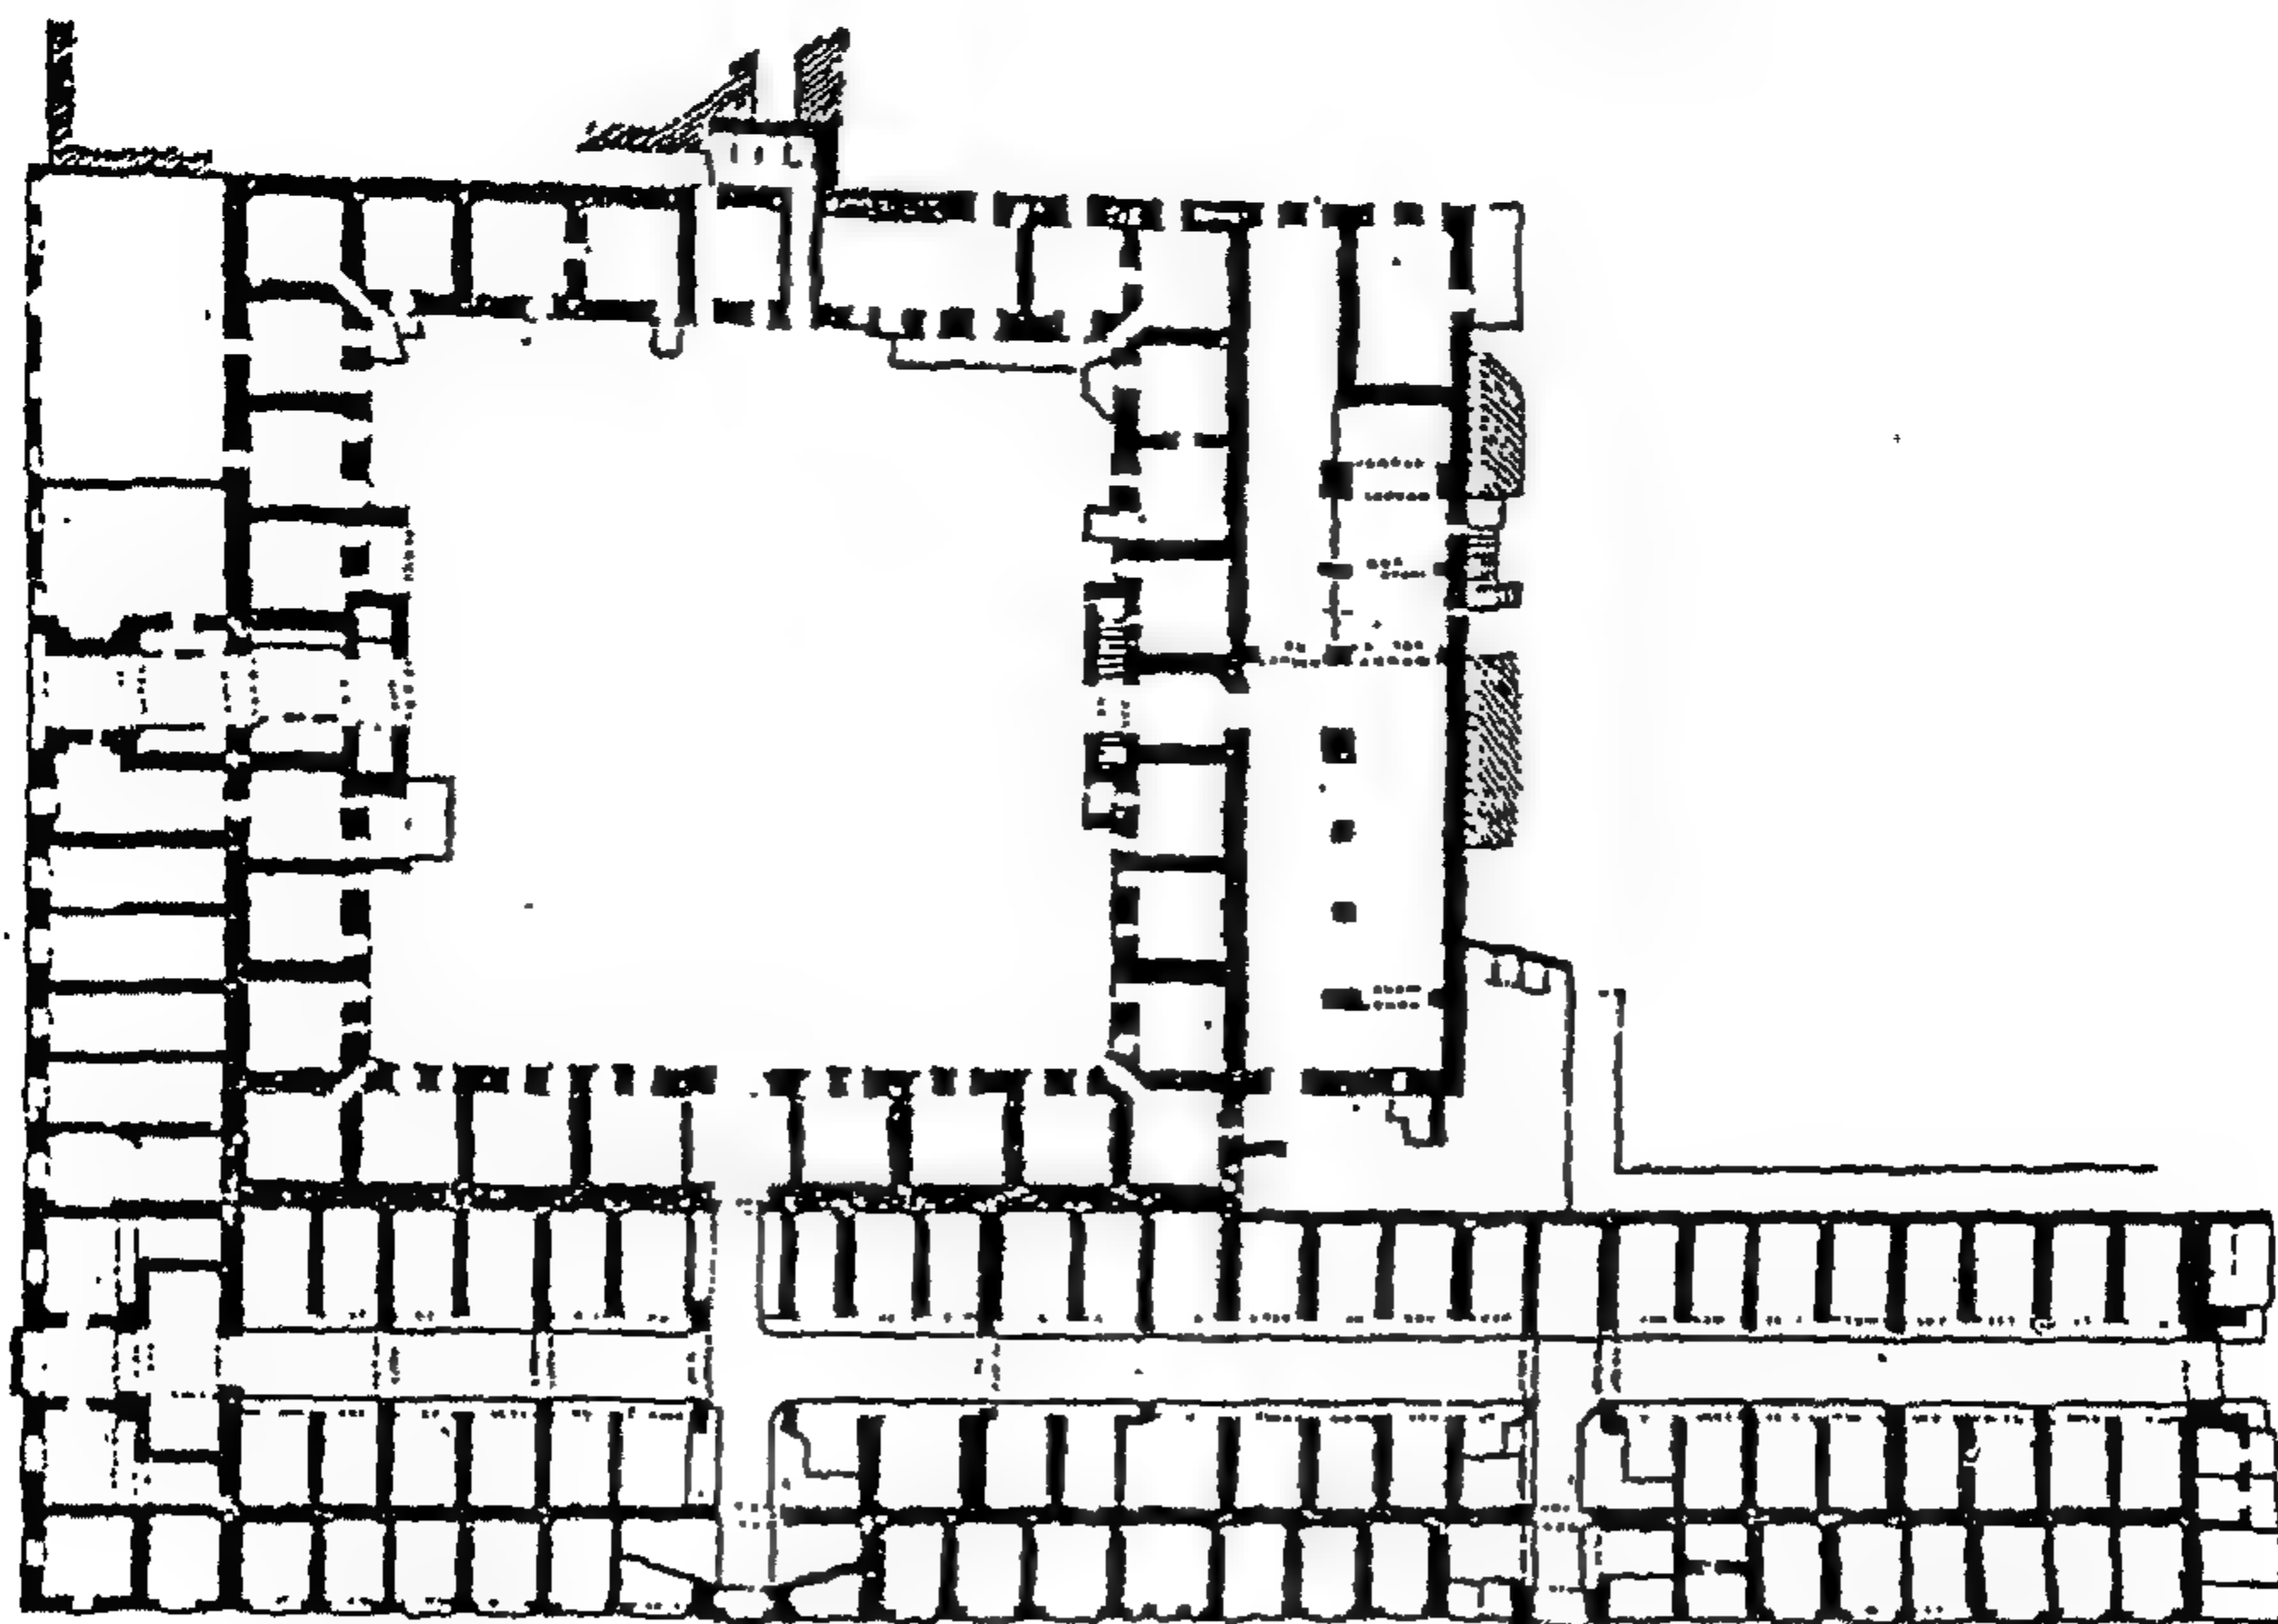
مسقط أفقى لبادستان رستم باشا المعروف ببادستان بورصة
